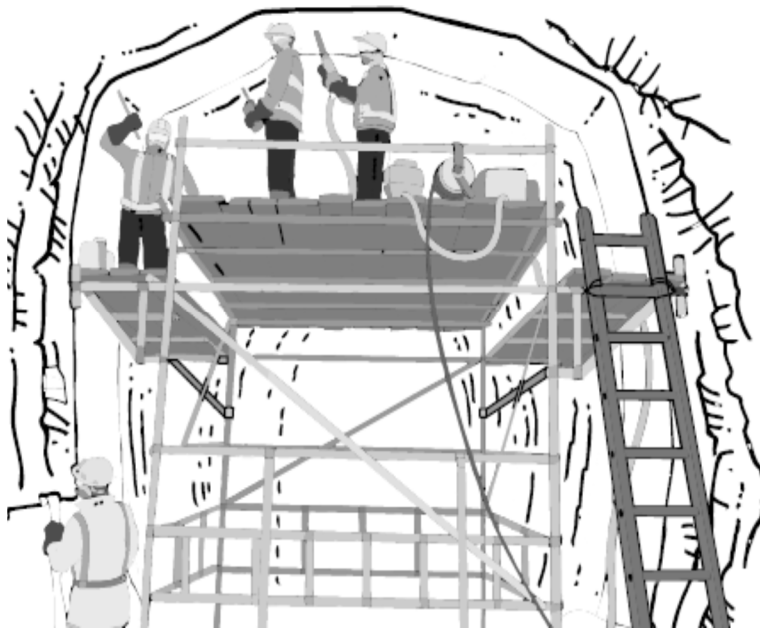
Esquema típico de la instalación de andamios para la colocación de las membranas y elementos de impermeabilización.
